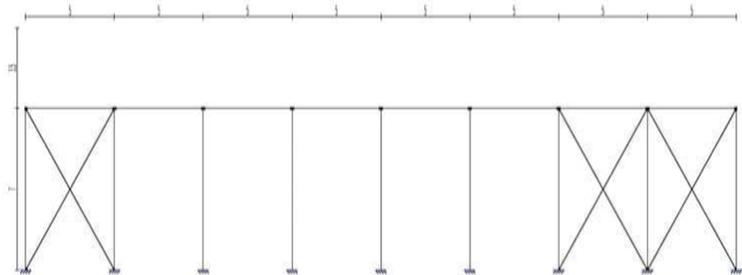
Vigas de atado y cruces de San Andrés en perfil derecho e izquierdo.
